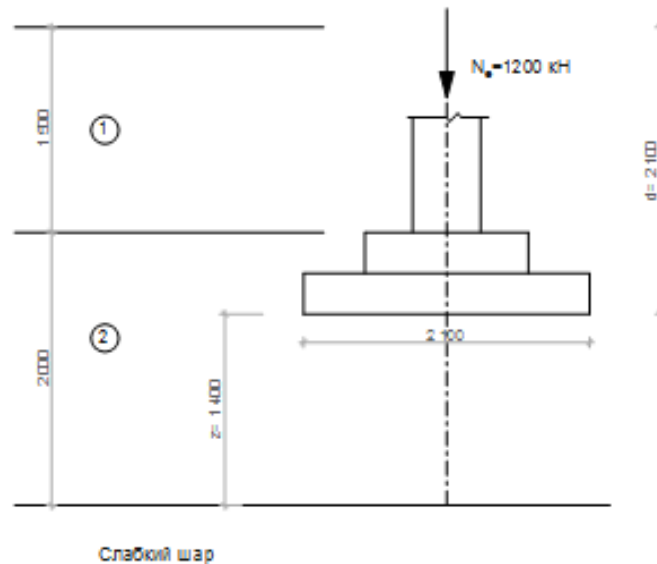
Розміщення фундаменту в ґрунті
